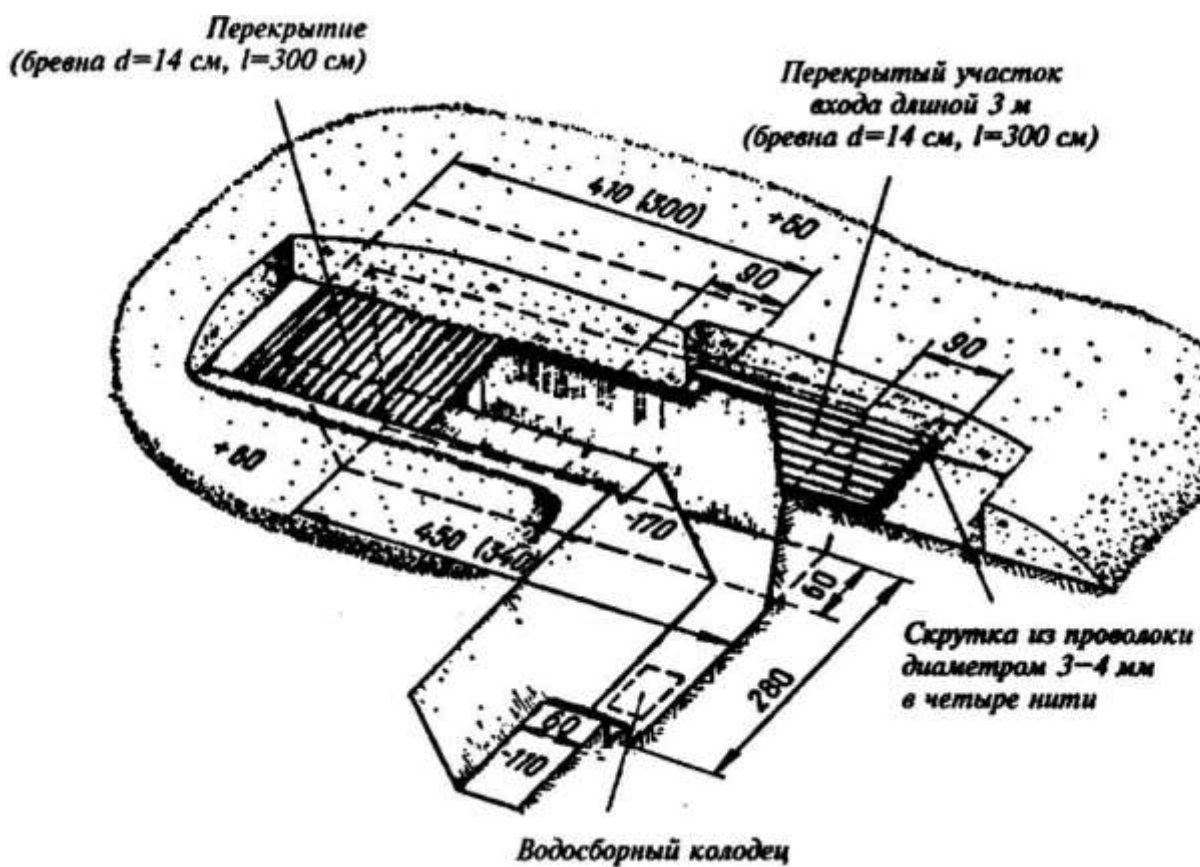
Перекрытая щель на отделение (расчет, экипаж)
